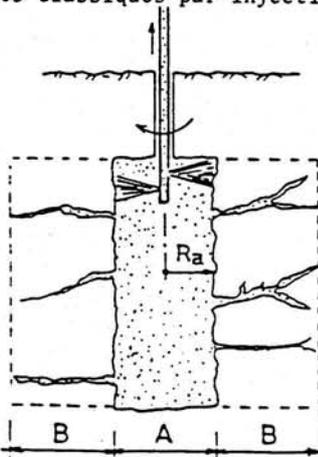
ZONES DE TRAITEMENT DU TERRAIN PAR JET GROUTING
